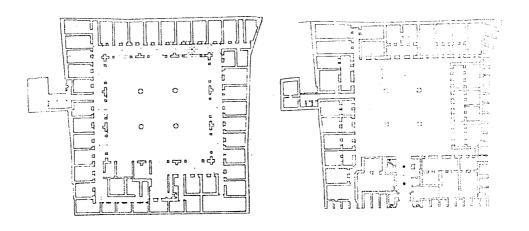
مسقط أفقي لحمام السنانية بدمشق . (عن : ايكوشار) .
